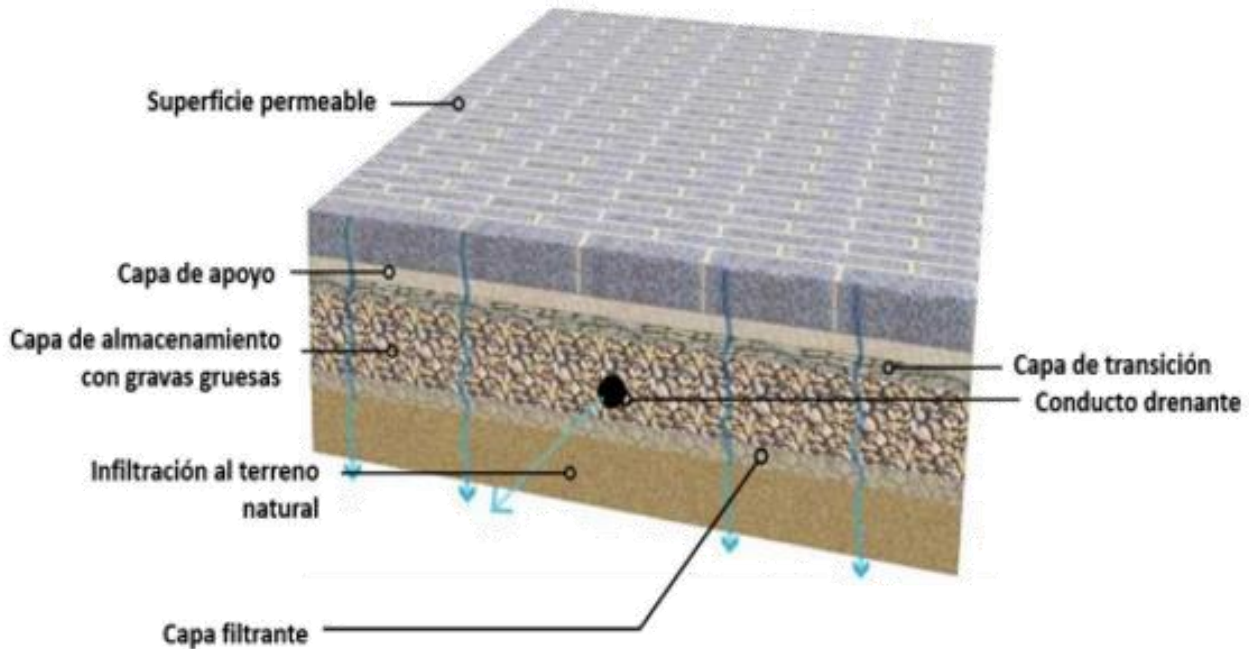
18. Ejemplo de las capas de un pavimento permeable.
